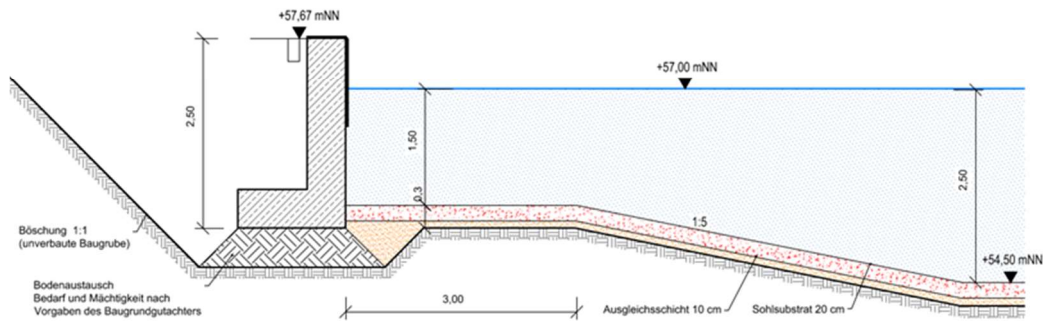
Variante 1 unabdichteter See mit Ortbetonwand
